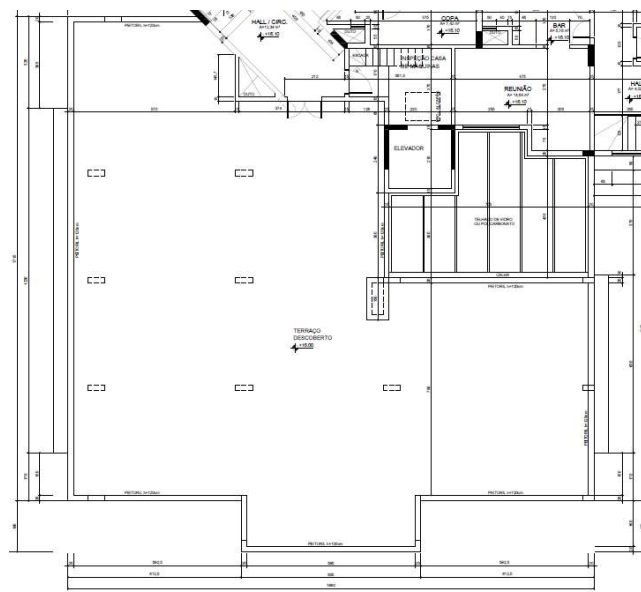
Planta arquitetônica do terraço ao qual será trabalhado
